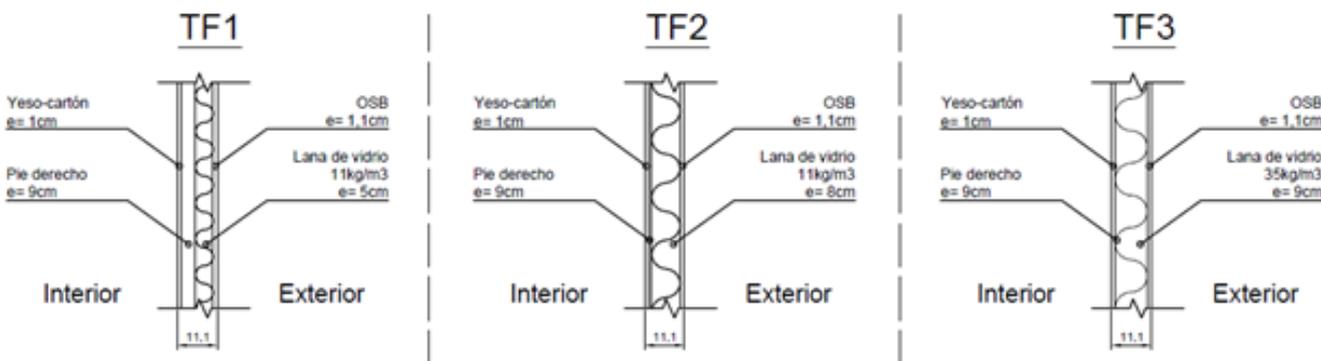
Escantillones de soluciones constructivas para madera. Fuente: (CIM UC, 2019b)
